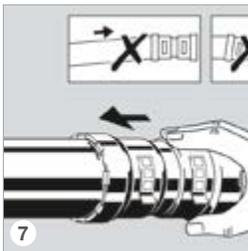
Pressverbinder – ohne zu verkanten – bis zum Anschlag auf das Rohr schieben.
